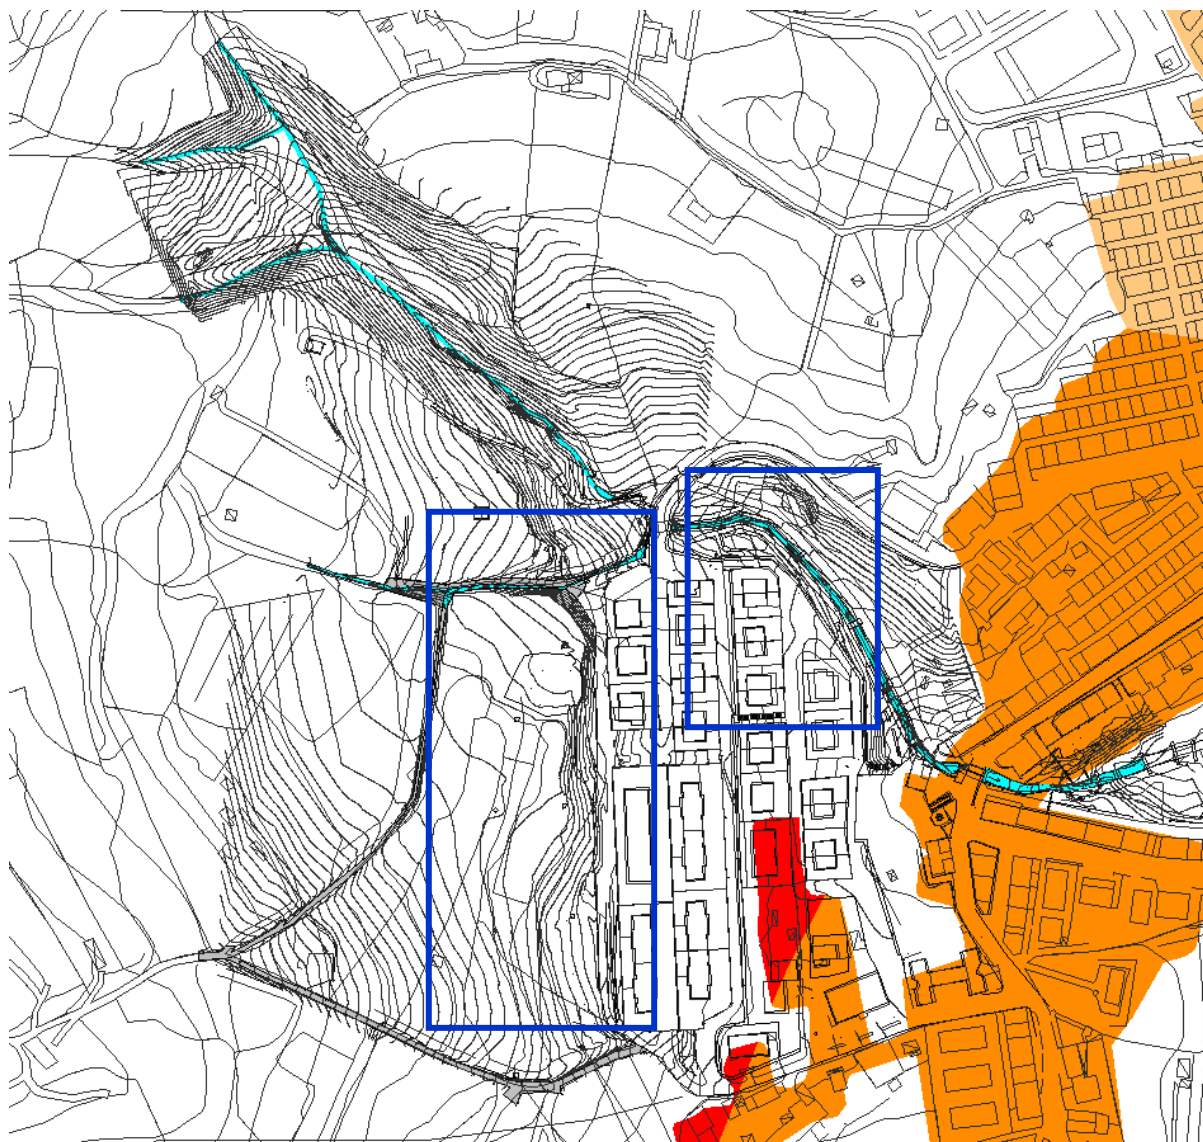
Perimetrazione PAI - Rischio:  basso (R1)  medio (R2)  elevato (R3)  molto elevato (R4)
